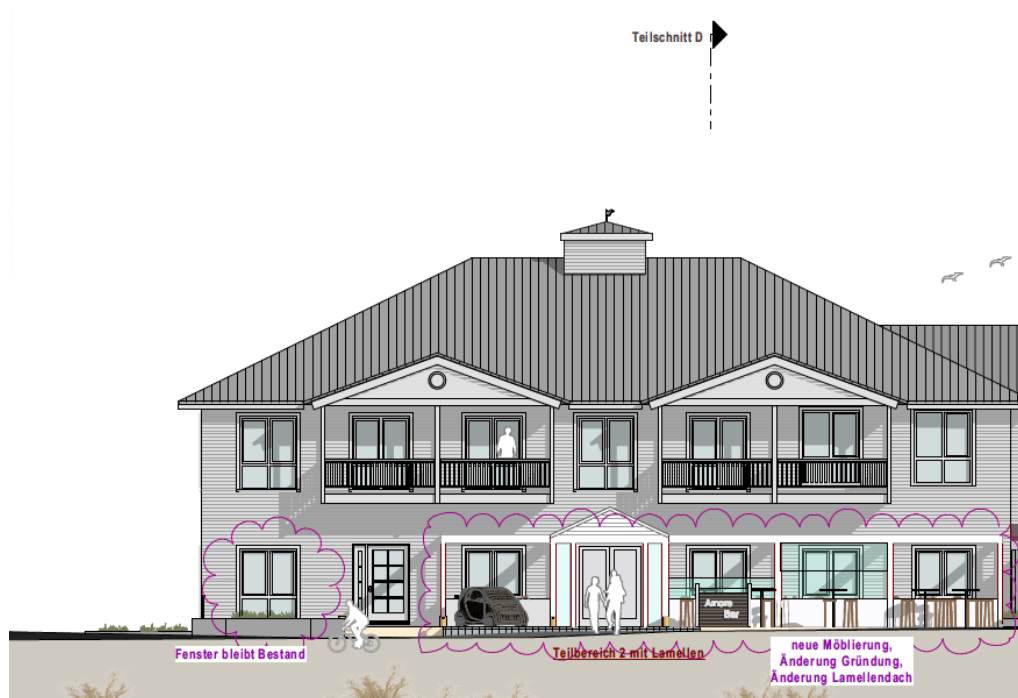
Nordwestansicht Abschnitt 2, Auszug Plan 1.4 (Quelle: Architekturbüro Ladehoff, Stand 08-2024)
